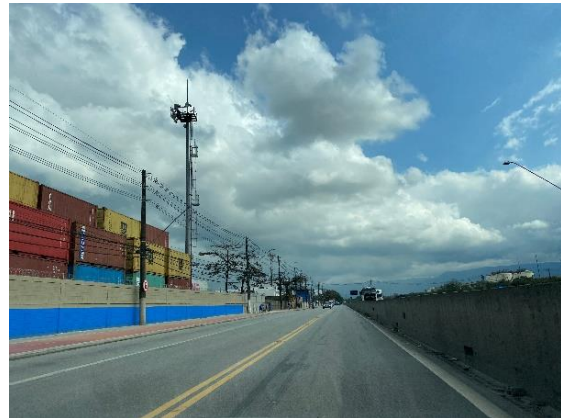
Sinalização horizontal ao longo da Av. Marginal da Via Anchieta.
